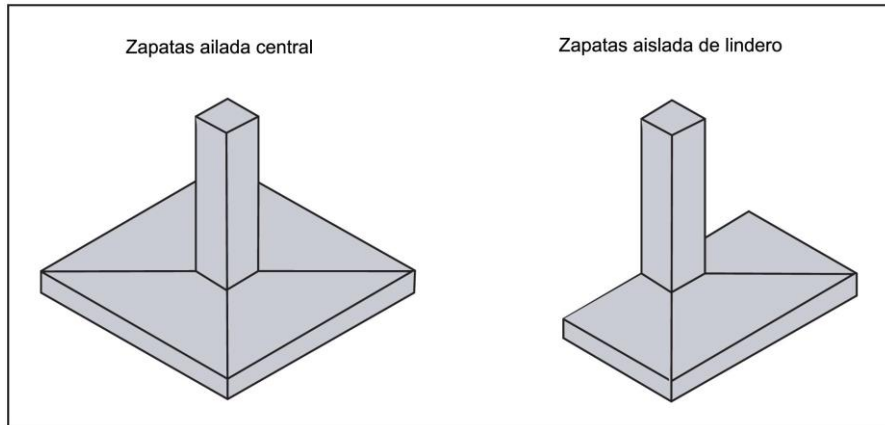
Zapatas. Fuente: (ANTAAC, 2016).
